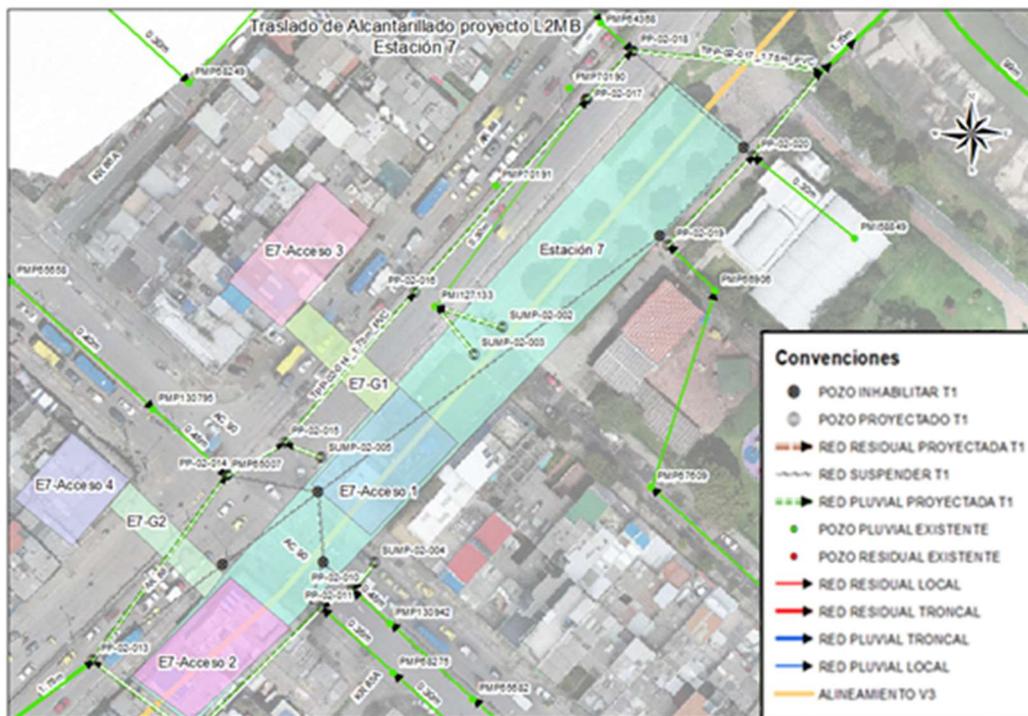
Traslado redes de alcantarillado Estación 7 Carrera 86 con calle 89A Red Pluvial
